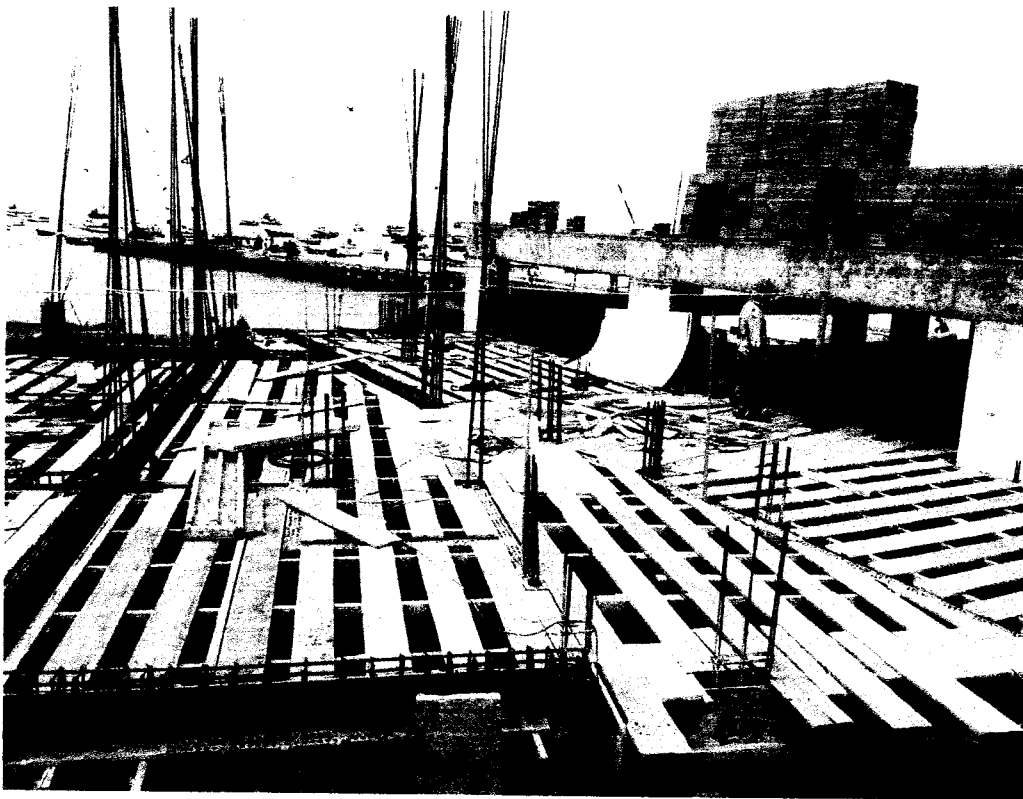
Encofrado y colocación de acero, en losa aligerada Zona de desinfección.
